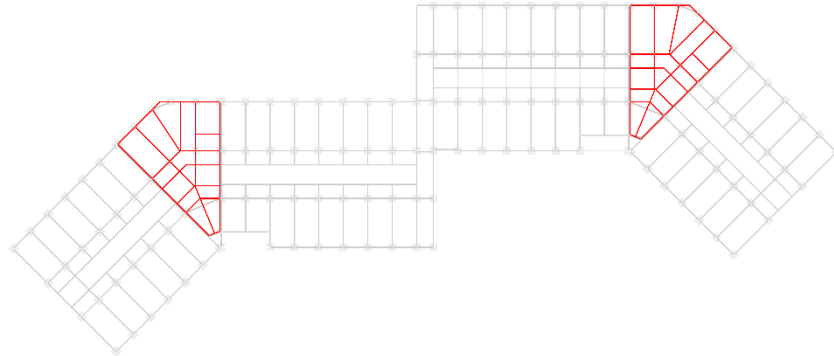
Sirkulasi Horizontal Lt-2 dan 3
